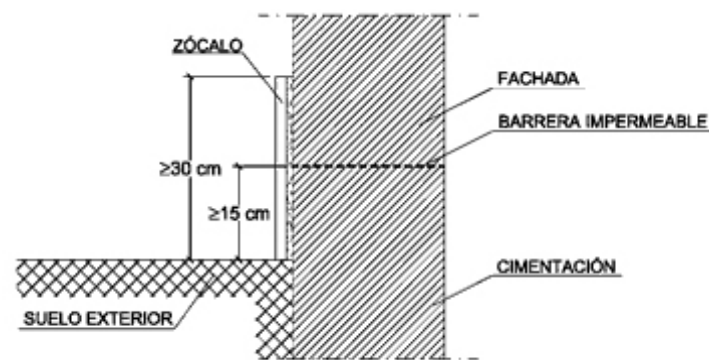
Ejemplo de arranque de la fachada desde la cimentación
